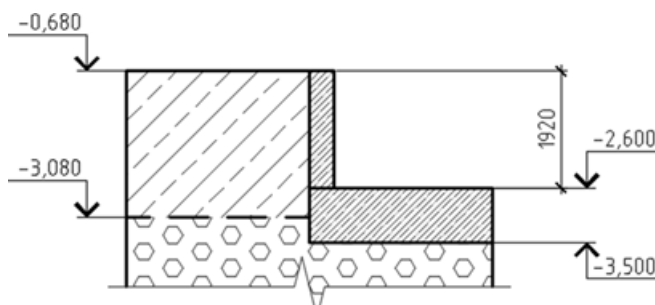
Схема розташування стіни цокольного поверху в ґрунті
